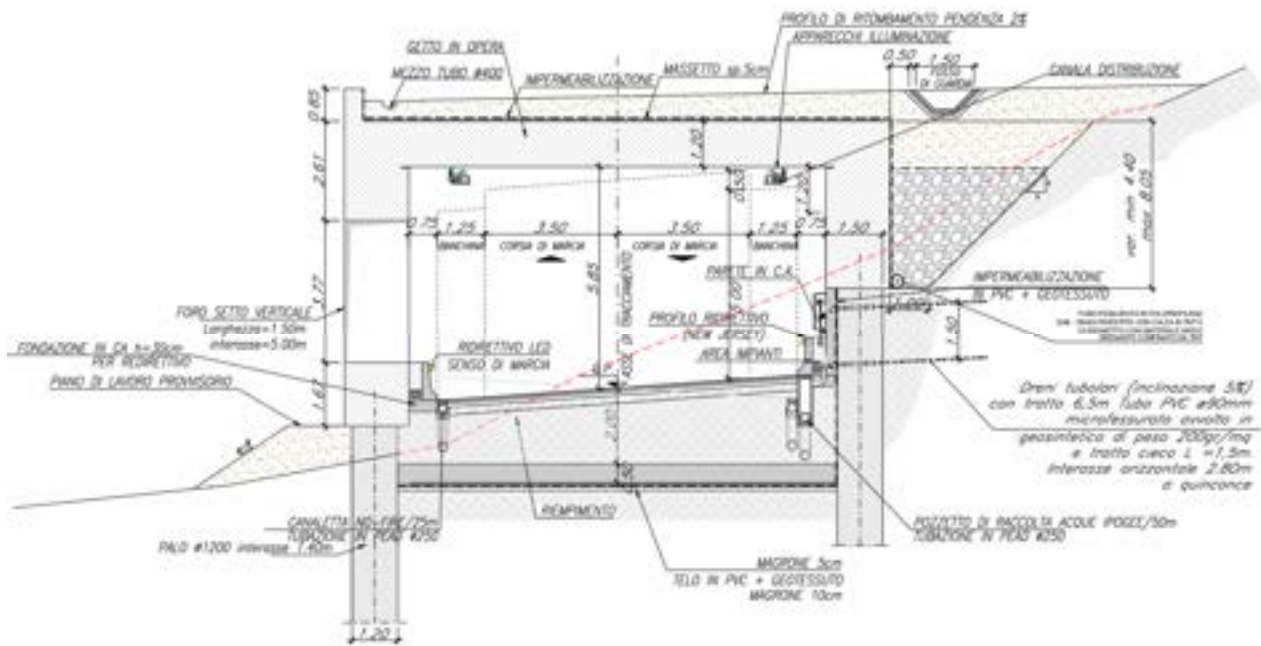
Sezione tipo 1 – Galleria artificiale
